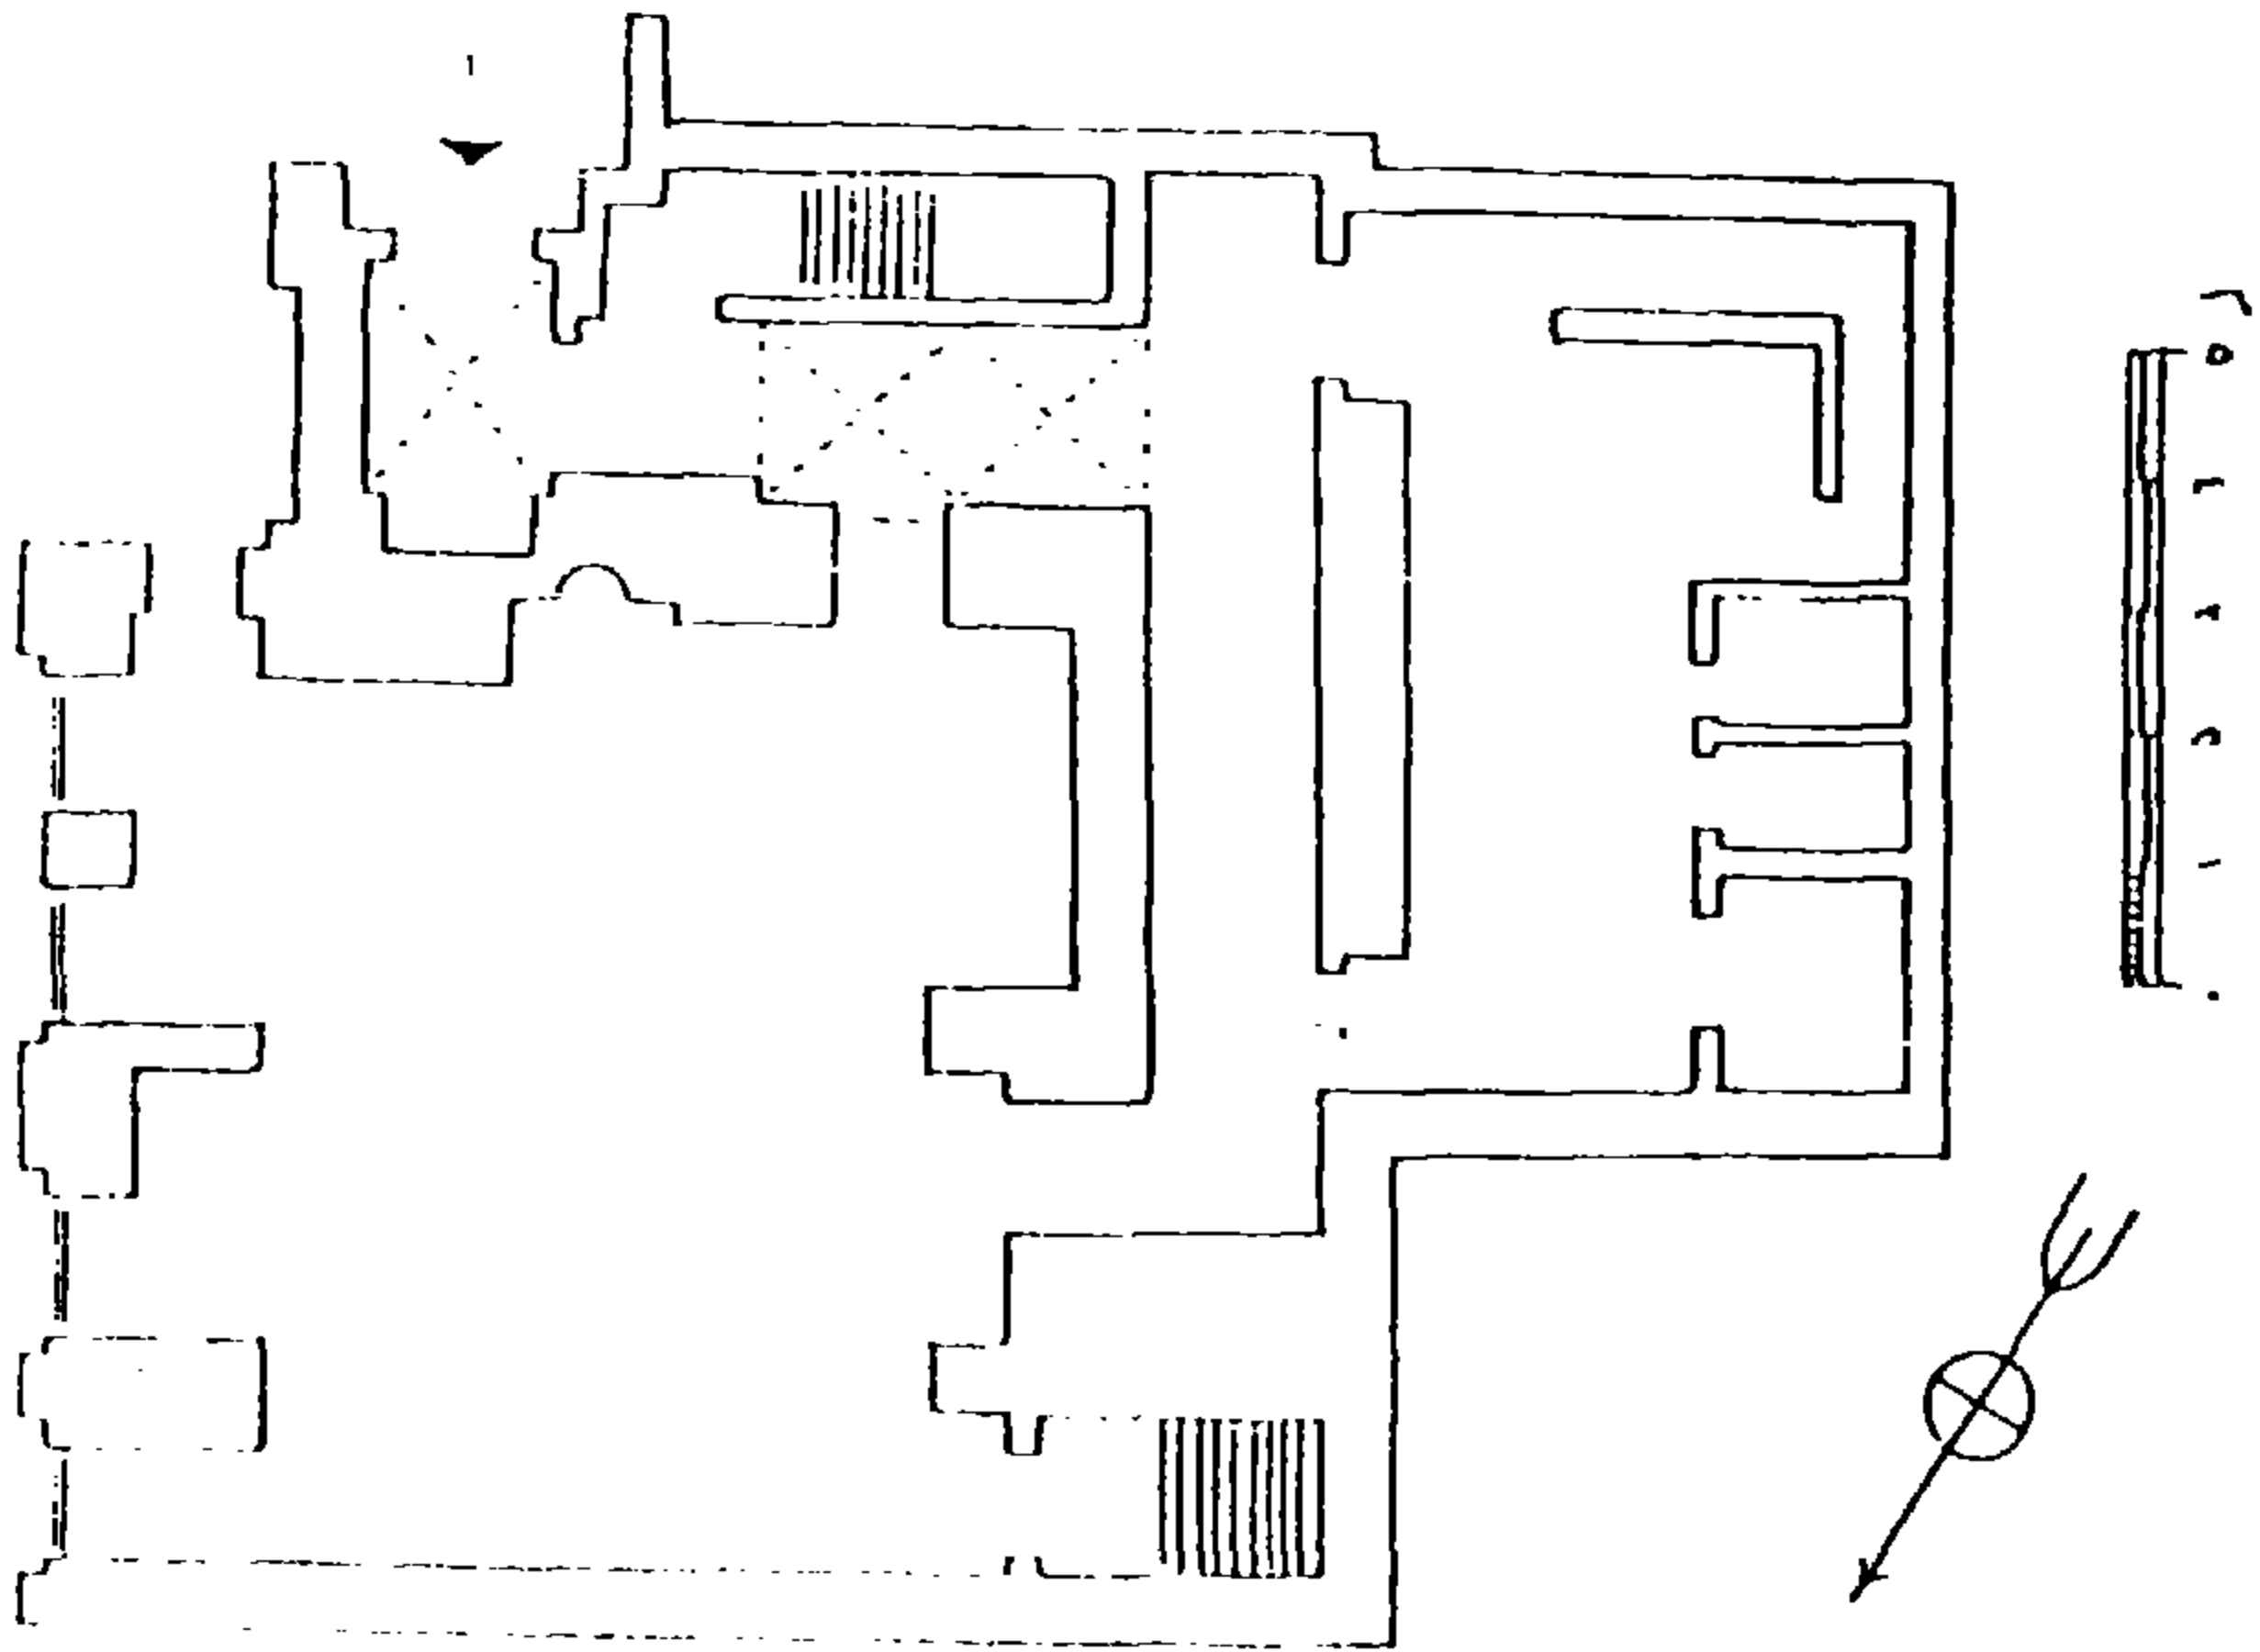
المسقط الأفقى لجامع داود باشا
